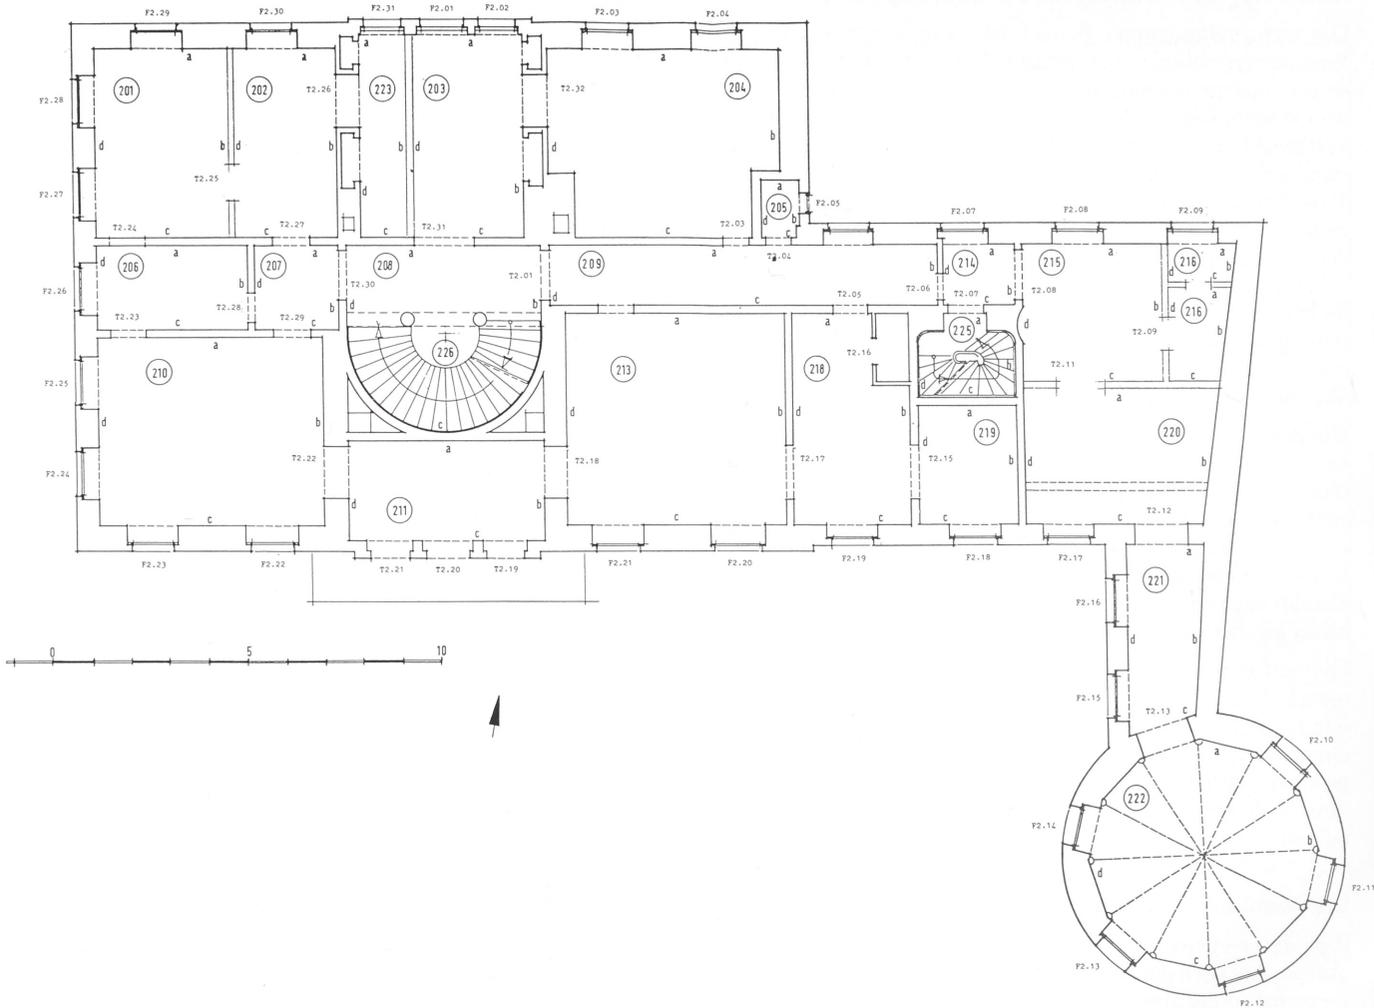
Villa v. Metzler, Frankfurt-Bonames, 2. OG. mit Kennzeichnung 2, Räume durchlaufend nummeriert, Wände im Norden beginnend mit a-b-c-d, Decken mit x, Fußböden mit y gekennzeichnet (Archiv Bingenheimer/Hädler).
